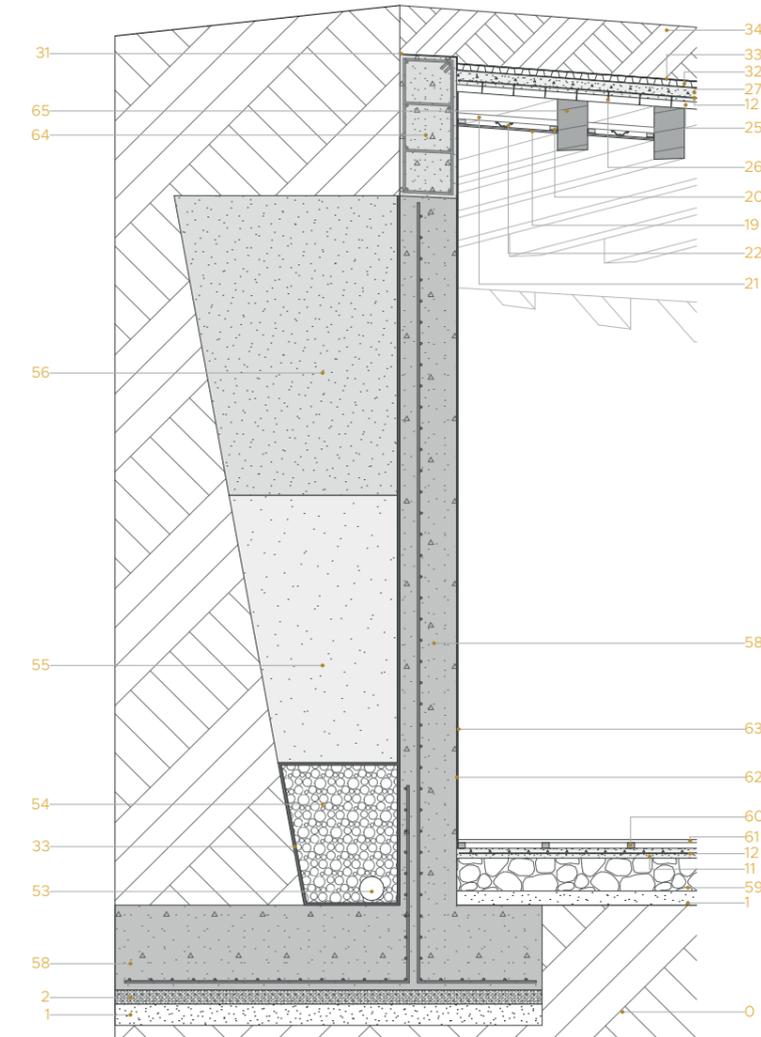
\_C4: detalle constructivo\_02, jardineras de capilla
